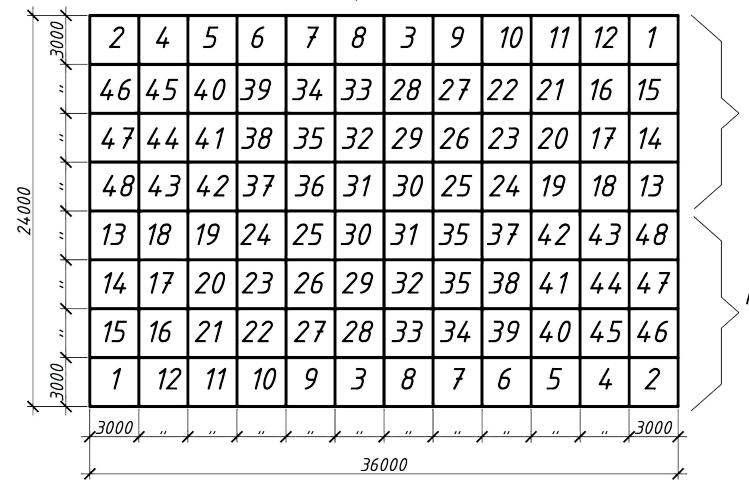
Послідовність (1...48) монтажу плит перекриття: I, II – зони монтажу баштових кранів 1 и 2.
